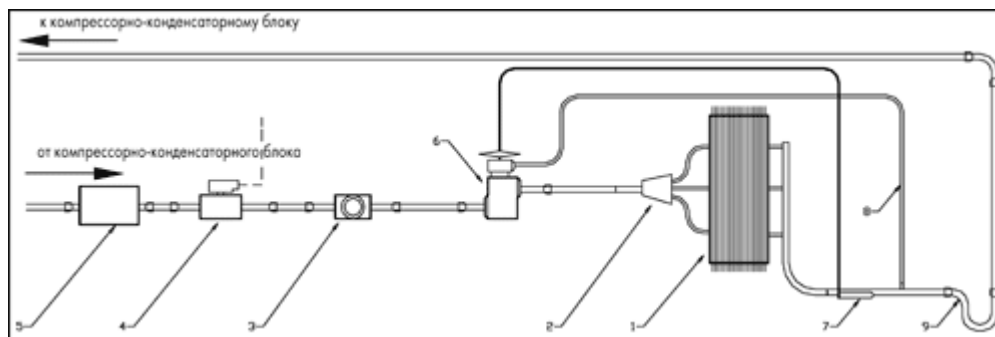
Схема соединения одного контура компрессорно-конденсаторного блока
